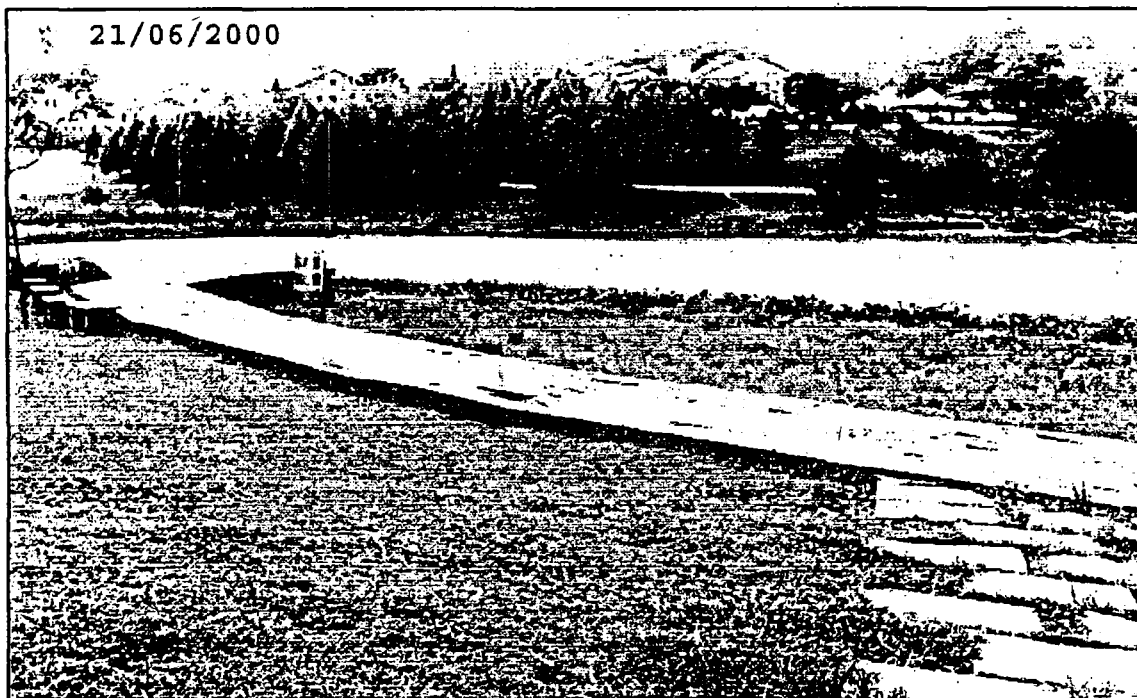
Vista do “Deck” de madeira existente no Parque Cidade de Toronto. Foto obtida em 21/06/2000.
